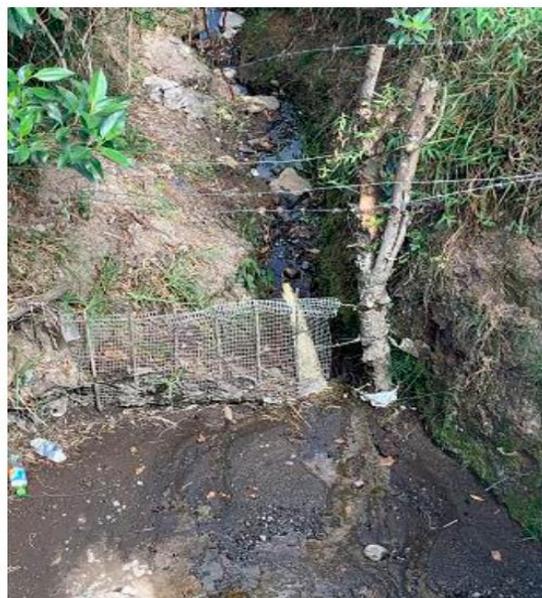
alcantarilla A.1 aguas abajo hacia el predio
